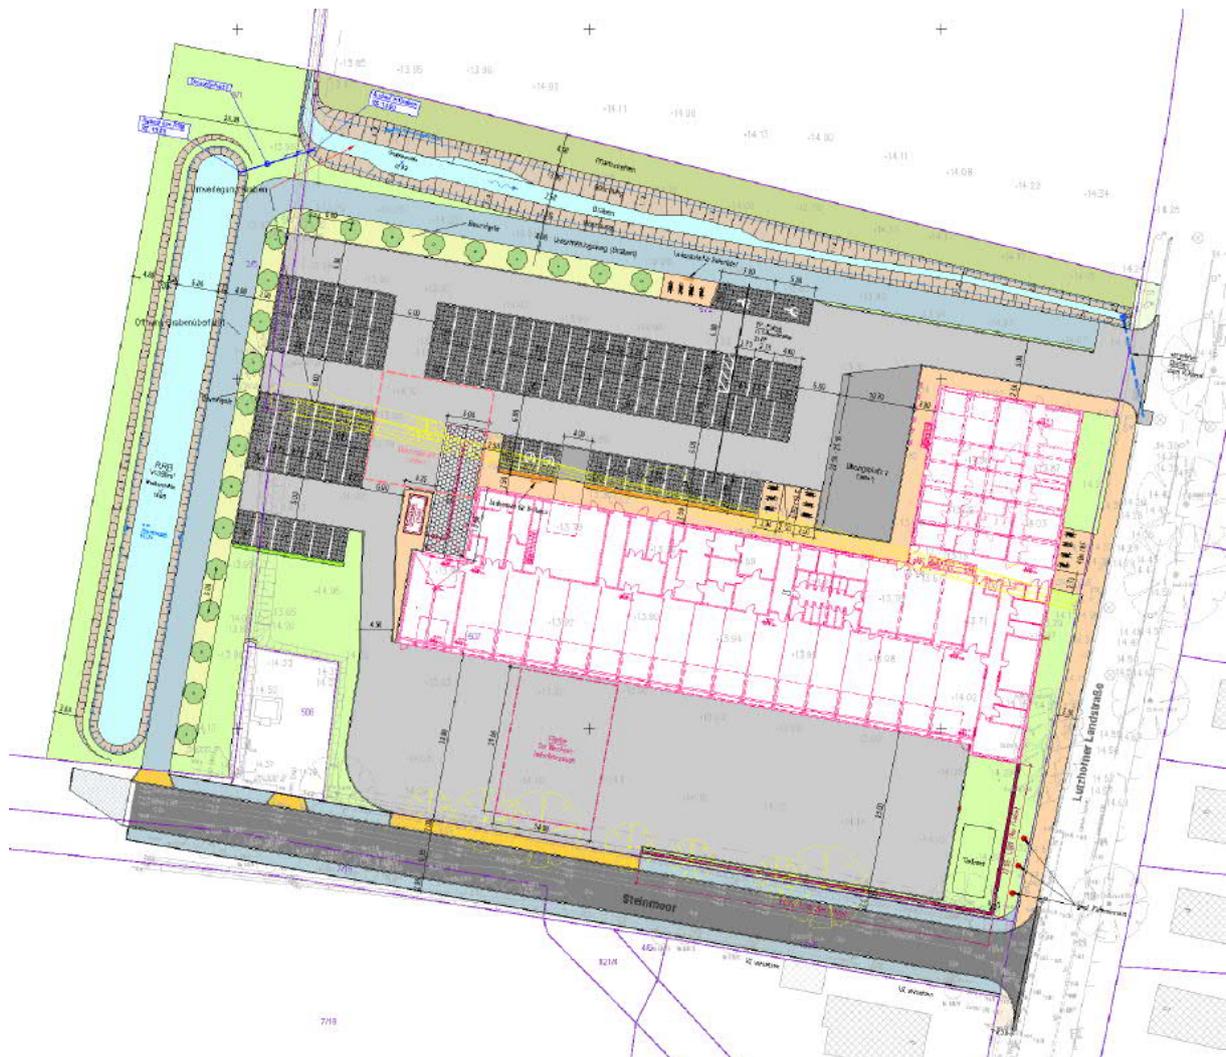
Lagedarstellung der flächenhaften Entwässerungsanlagen
